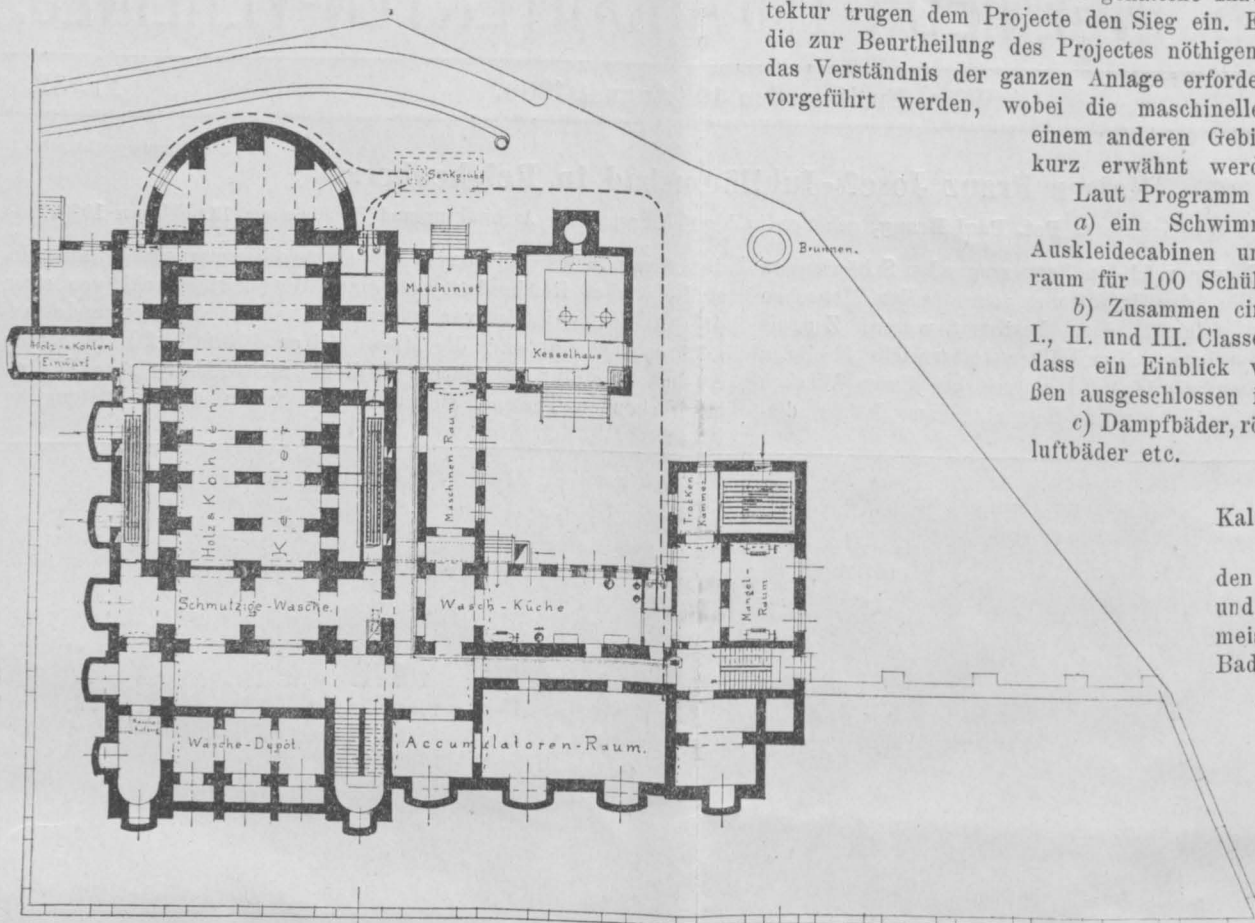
Souterrain-Grundriss. 1:500.
